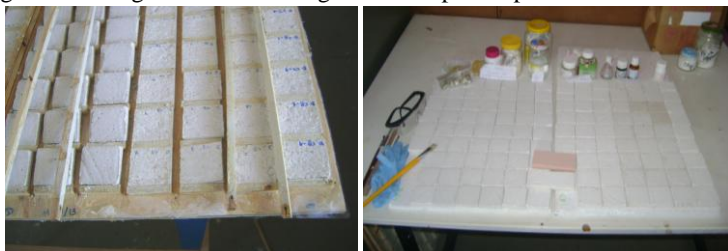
Imagens da colocação das argamassas nos tabuleiros
